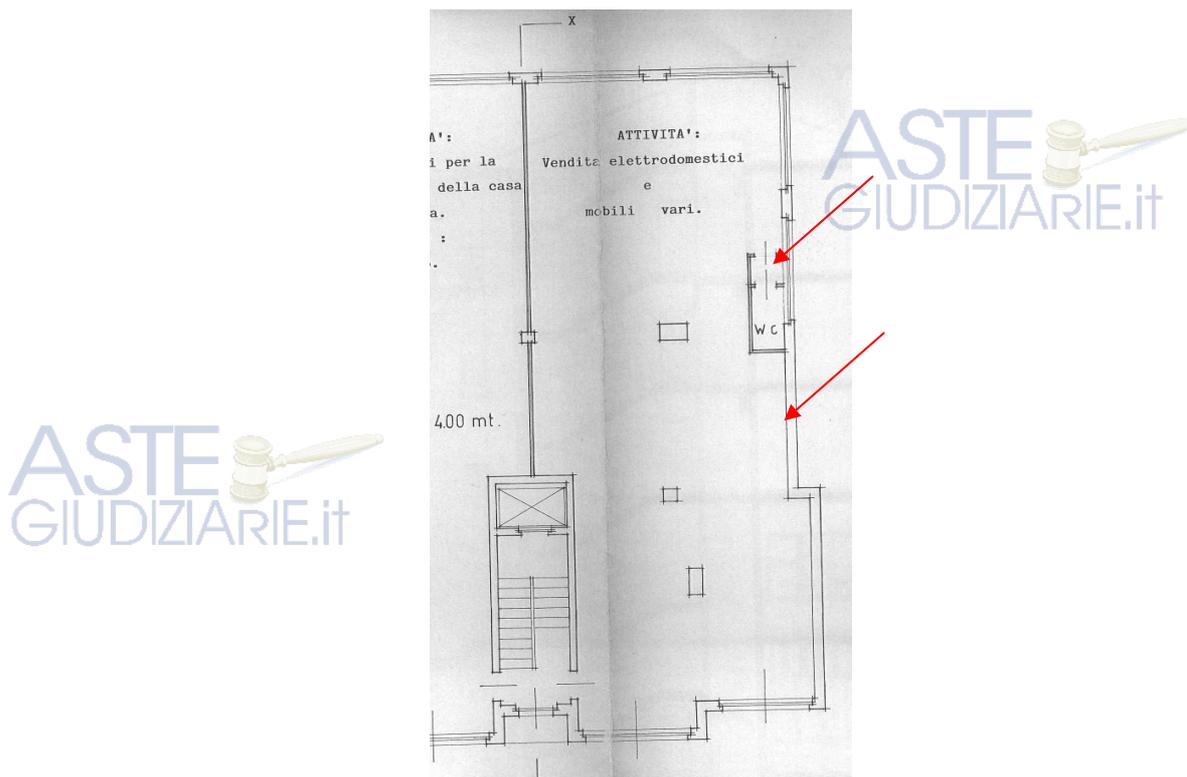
Estratto di Licenza Edilizia n.341/1971 con individuazione dell'antibagno e finestra mancante
